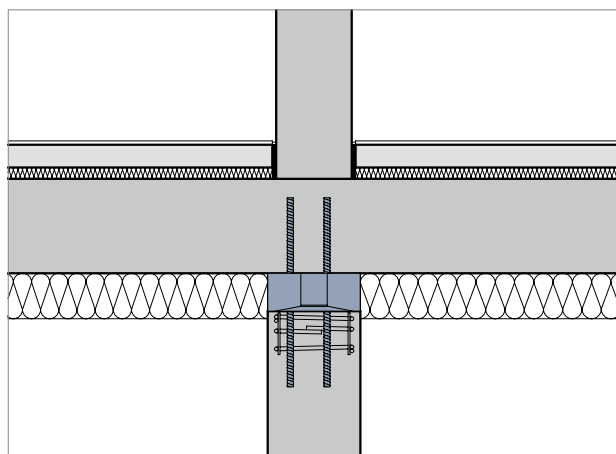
Doorsnede met gedetailleerd Schöck Sconnex®-model
